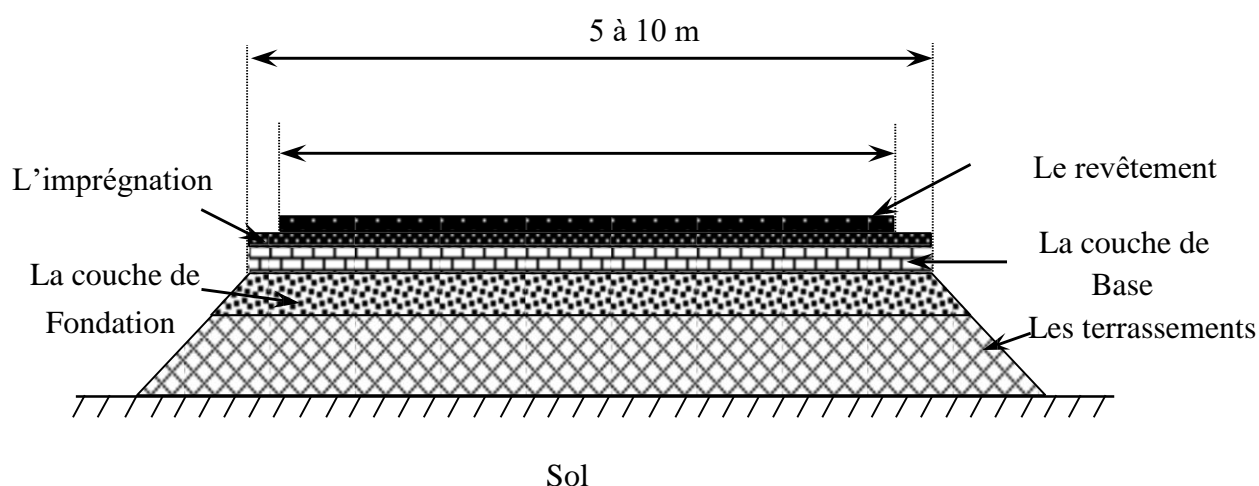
Coupe transversale type d'une chaussée saharienne.
